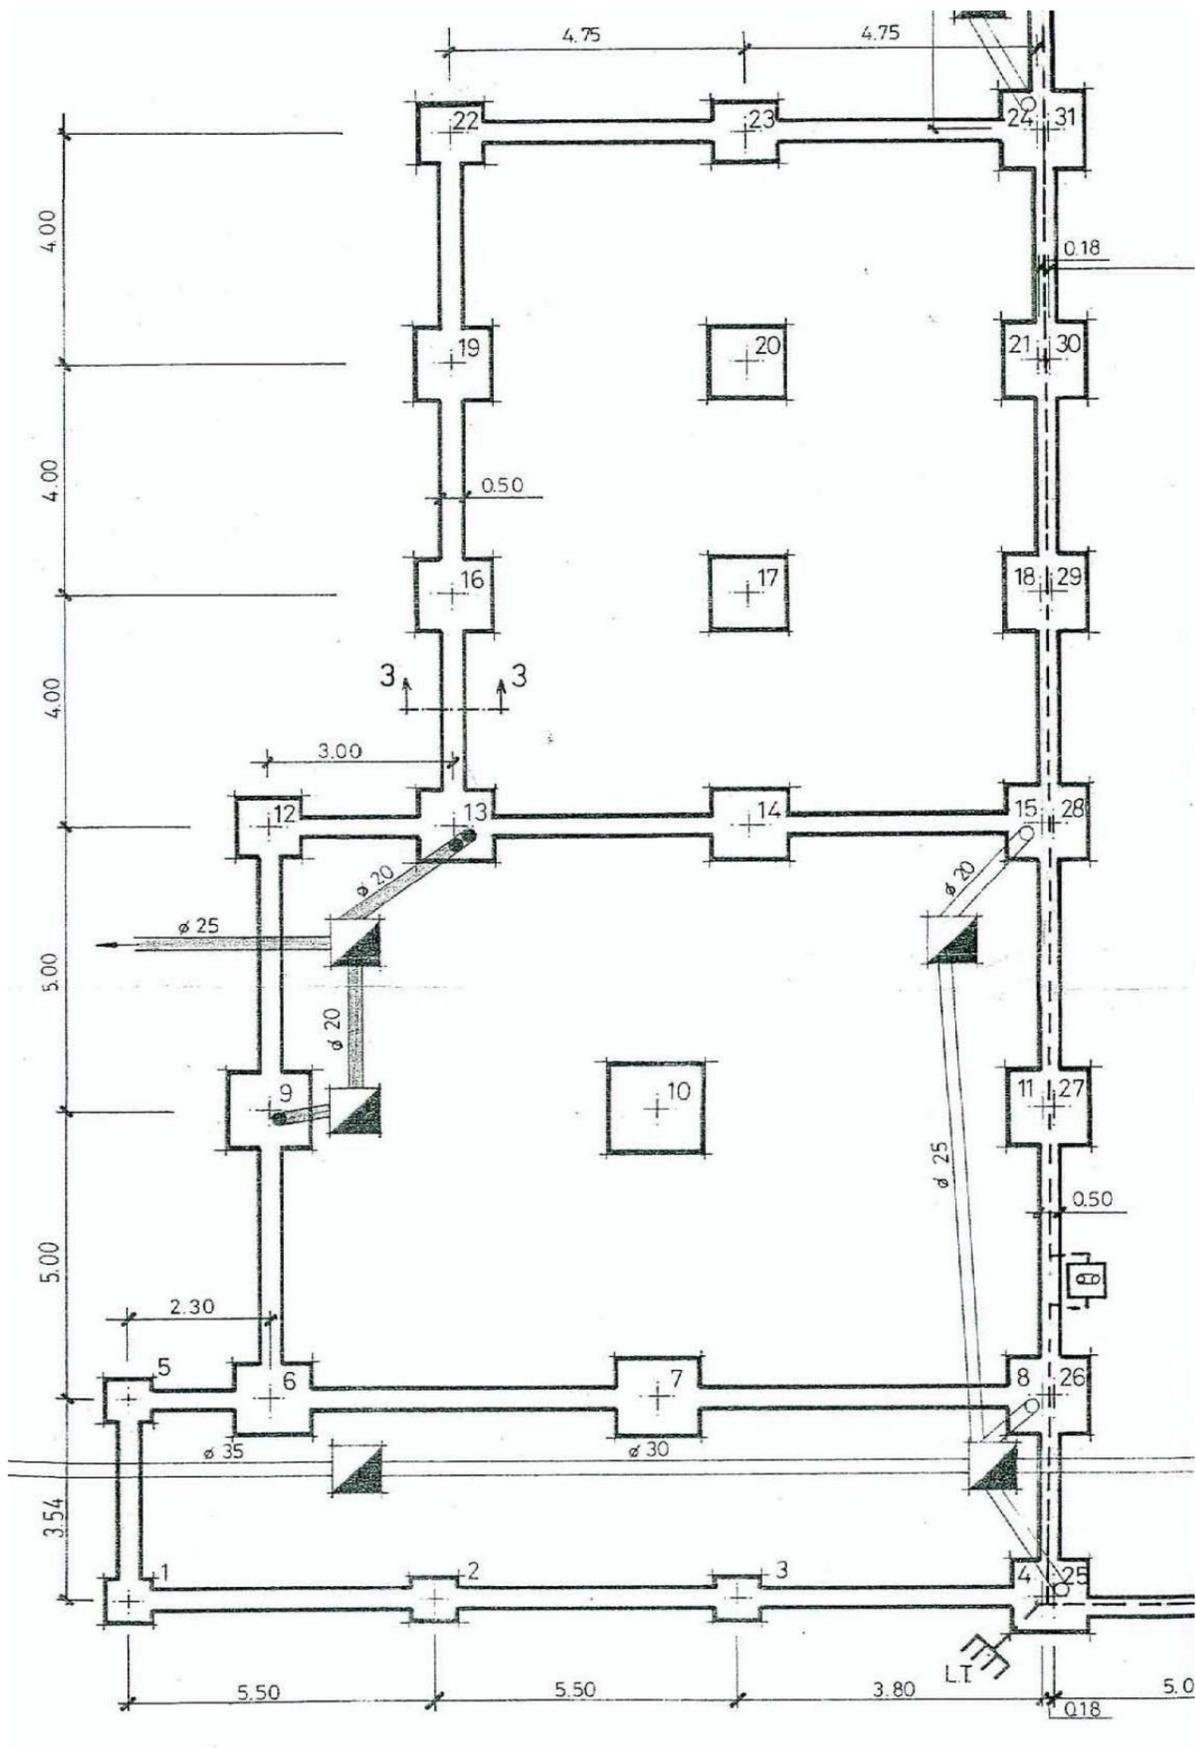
Extracto Plano cimentación edificio singular. Fuente: La empresa
